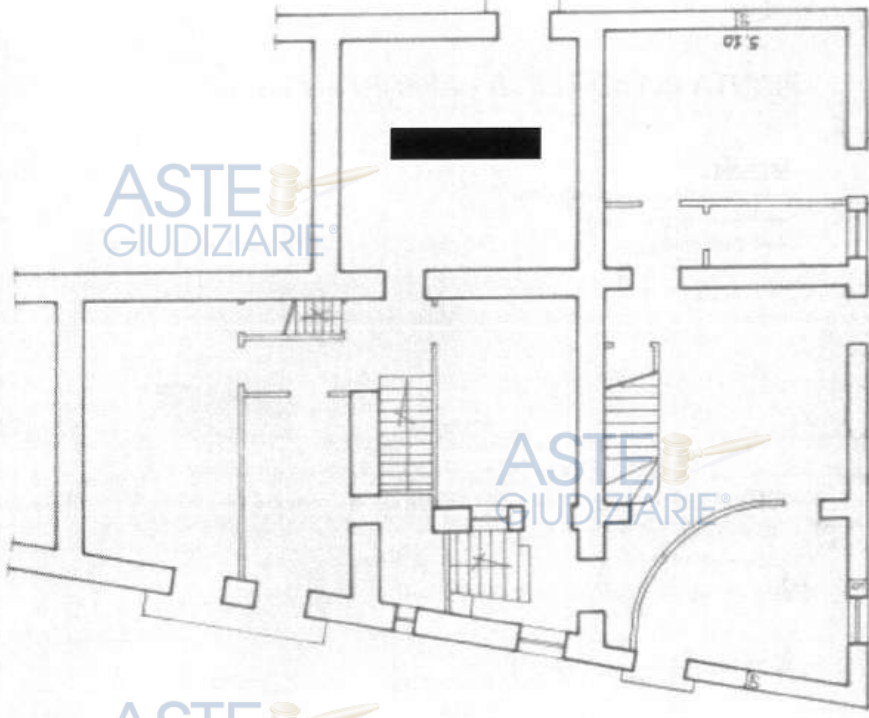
Pianta Piano 1° allegata alla "Concessione per l'Esecuzione di Opere Edilizie n. 571/1998 prot. n. 13666 del 27.10.1998
